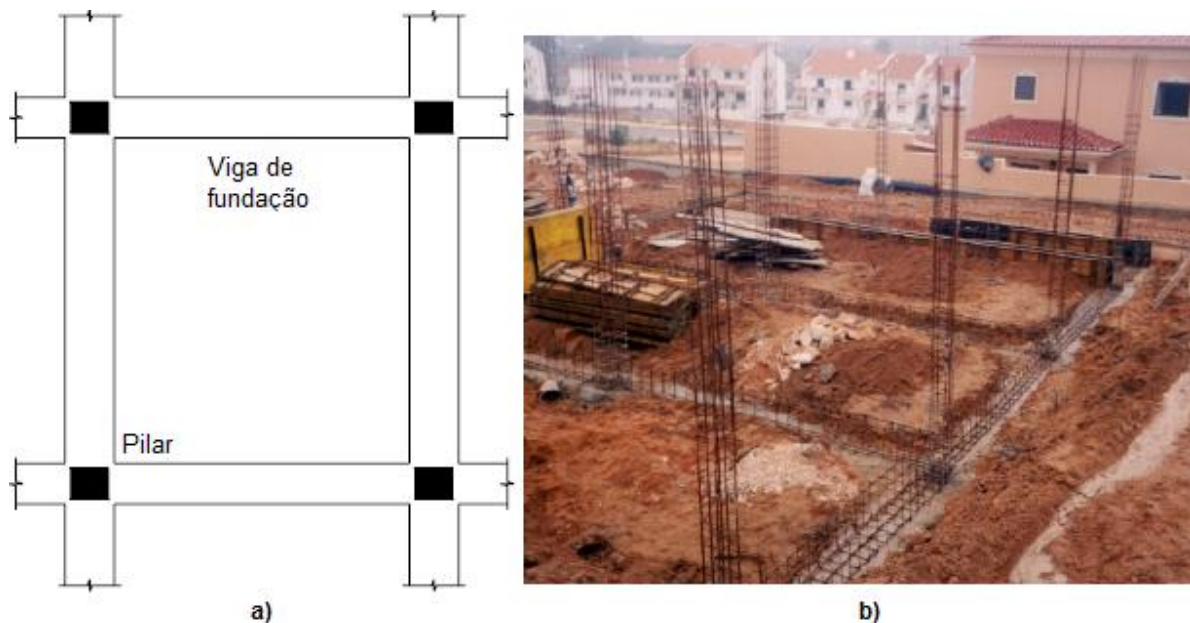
Grelha de fundação: a) esquema; b) construção [adaptado de 46]
